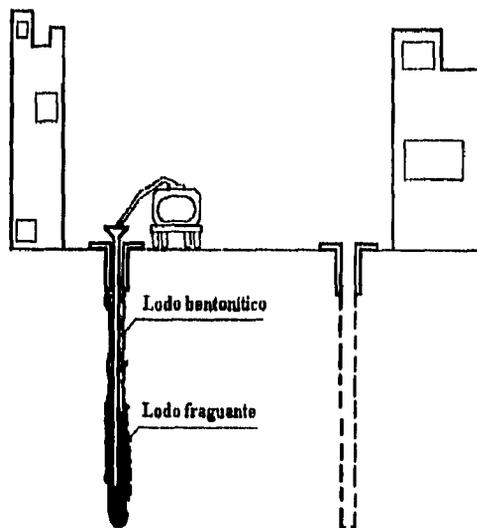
Excavación de zanjas e introducción de lodos bentonítico y fraguante.
